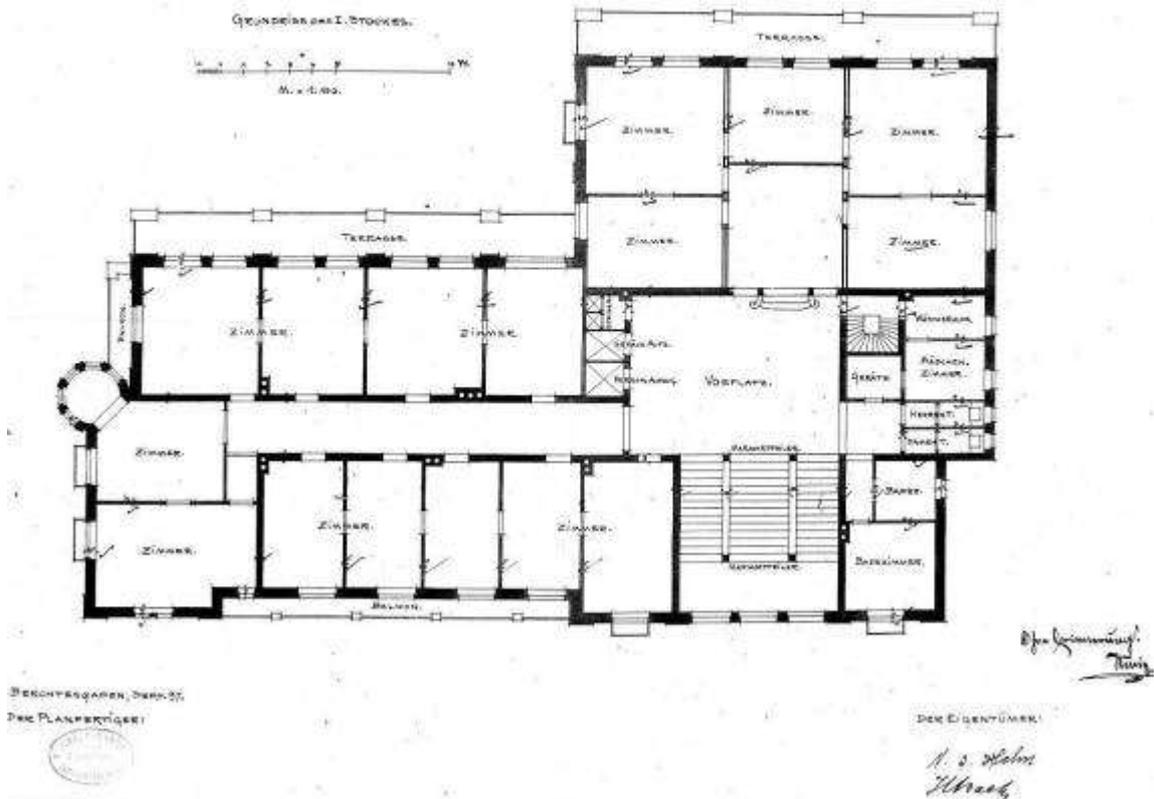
Grundrisse des Grandhotels Berchtesgaden, erbaut 1897/98
